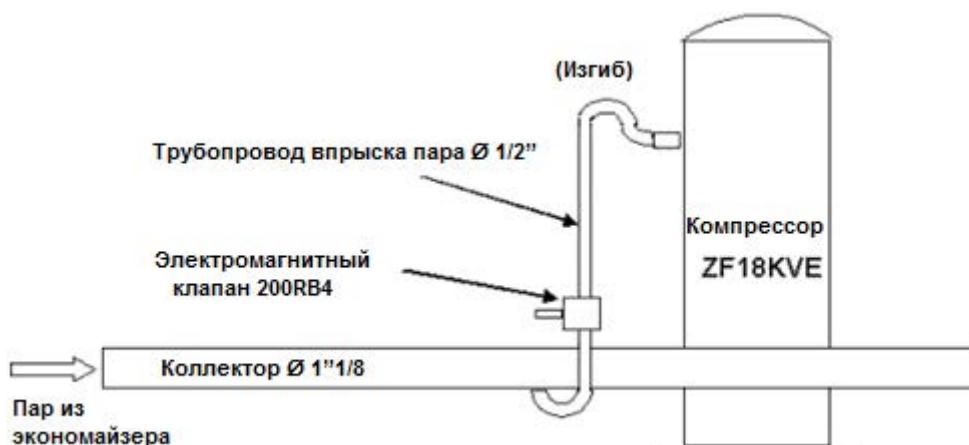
Пример трубной обвязки для впрыска пара в установку из пяти компрессоров ZF18KVE
